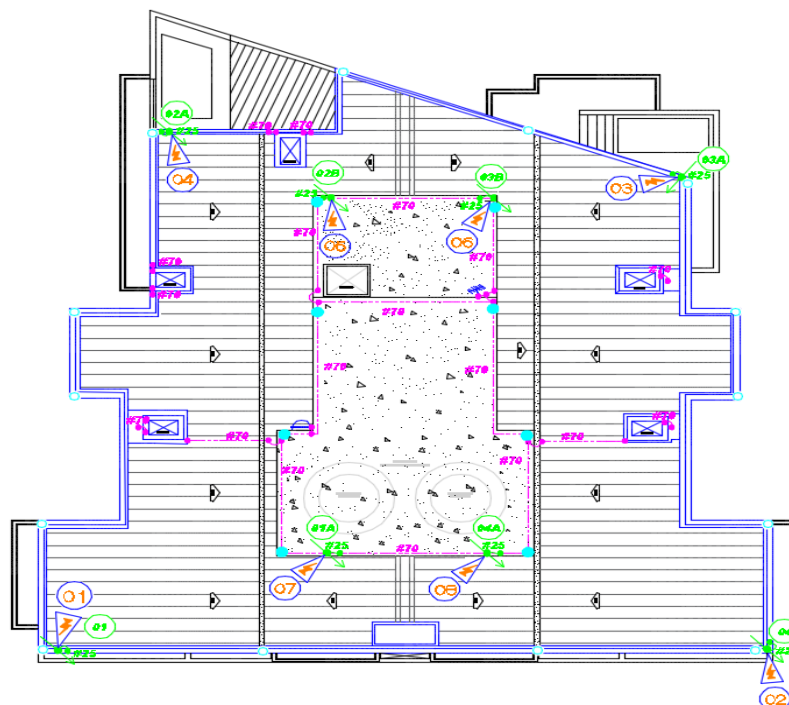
Croqui da Planta DE-9548-008 – com os pontos de Medição de Continuidade – Planta de Cobertura
